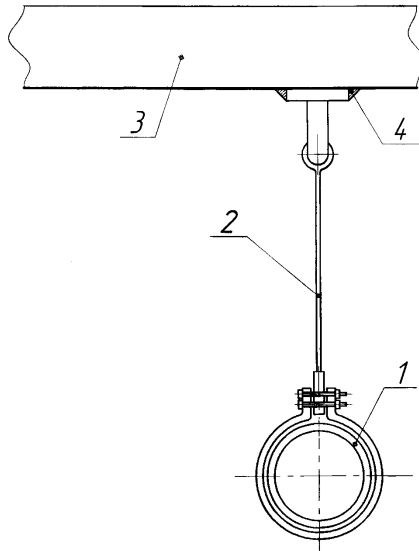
Пример назначения границ между опорными конструкциями и строительными конструкциями
